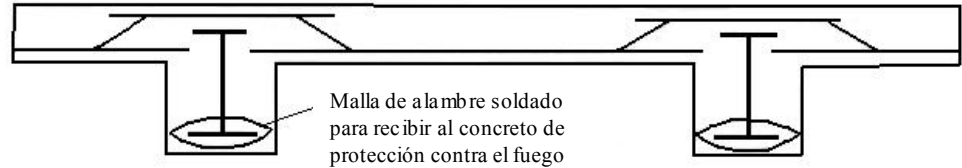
Losa de concreto reforzada en una dirección con viga embutida en concreto.
